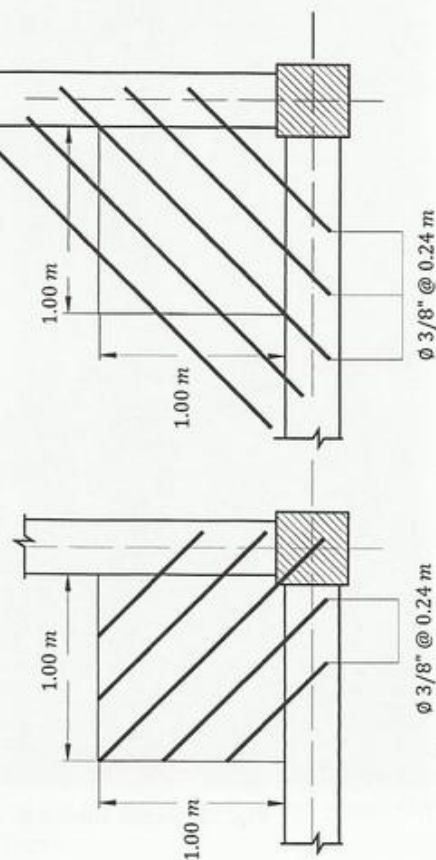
Detalle de la armadura en las esquinas (Ejemplo 12.3)
